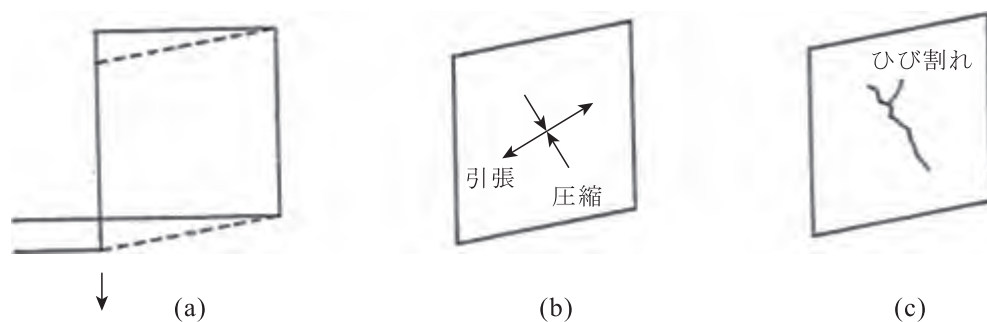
不同沈下により基礎梁に生ずるひび割れの例
